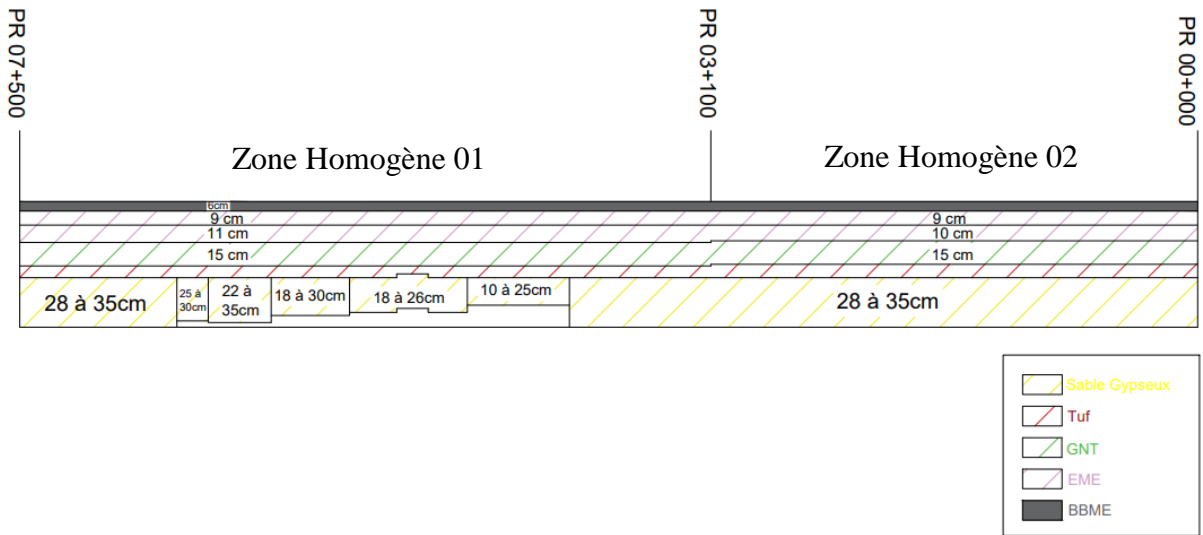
Dimensionnement de la chaussée BBME/EME–sens retour-.
